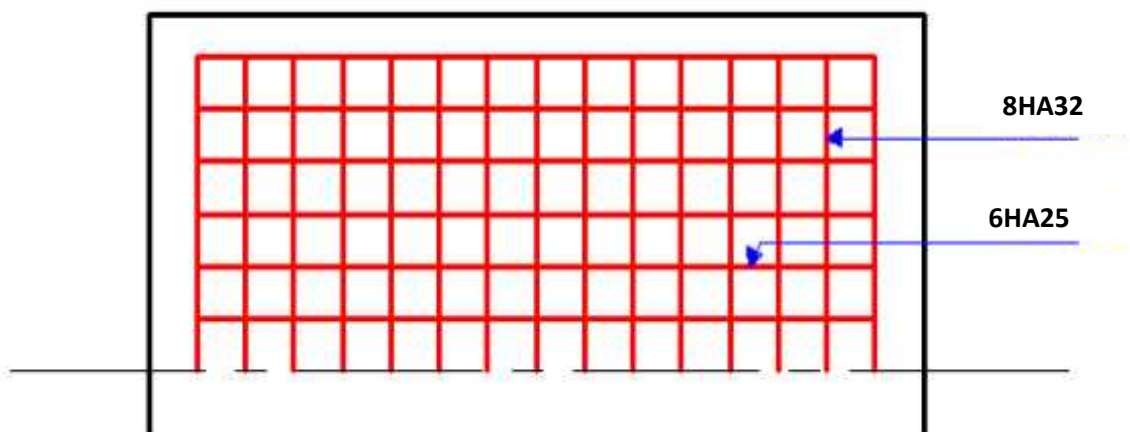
ferrailage de mur en retour (vue en plan)
